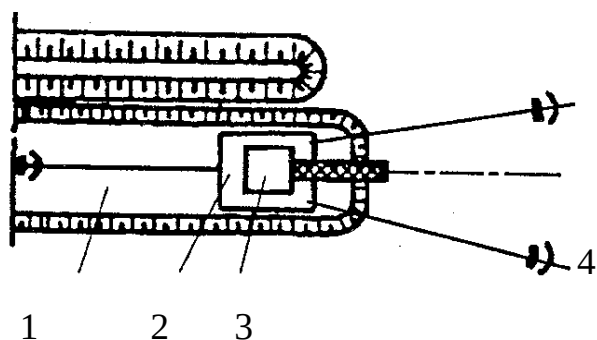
Схема разработки грунта экскаватором на понтоне[9]:
